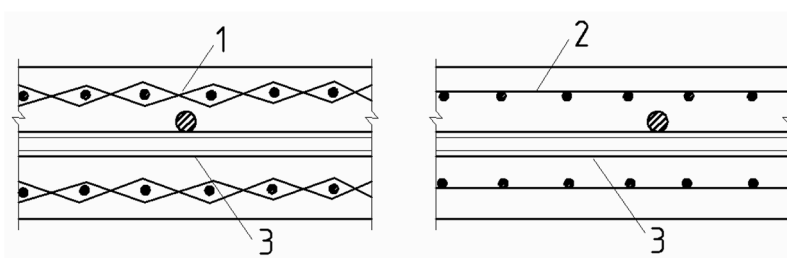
Комбинированное армирование армоцементных конструкций: 1 – частые тонкие тканые сетки; 2 – частые тонкие сварные сетки; 3 – стержневая или проволочная арматура
